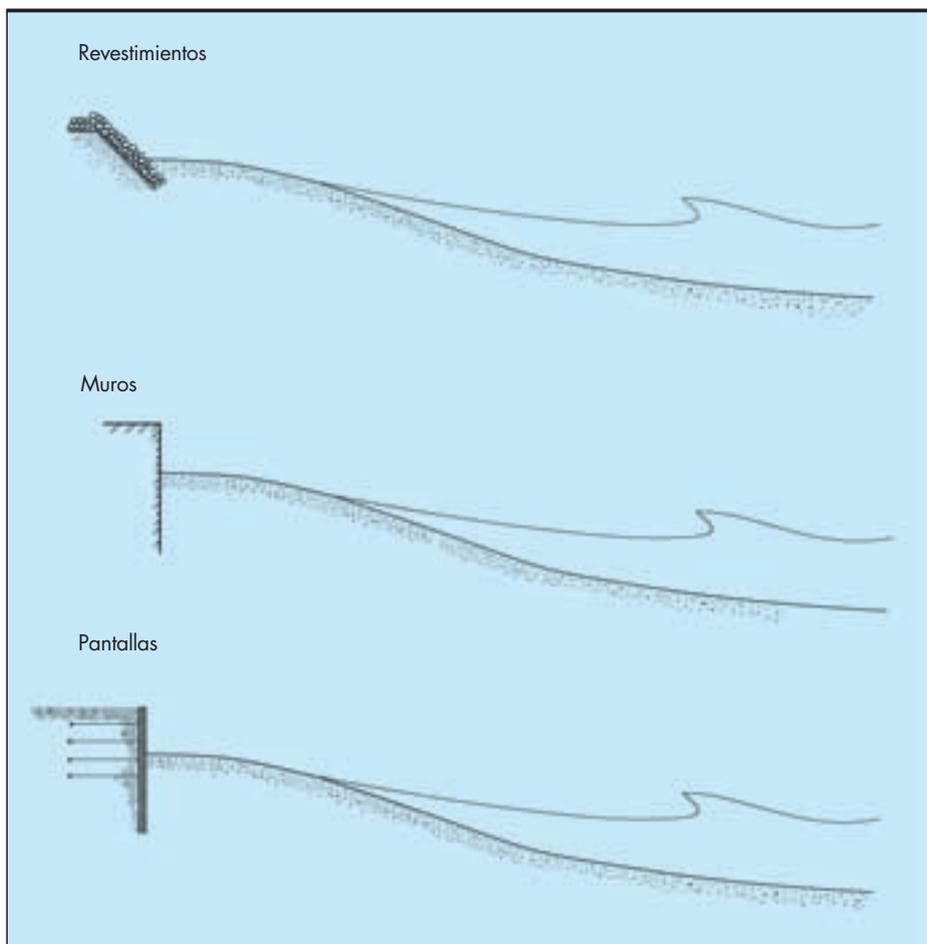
Tipo de obras de protección lineal por su estructura.
